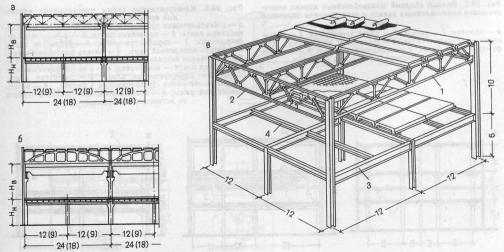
Опирание плит перекрытия на ригели в зданиях с верхним крановым этажом
